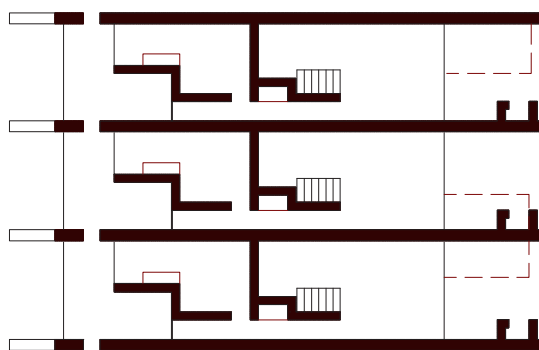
Planta baixa Projeto São Vctor - SAAL
